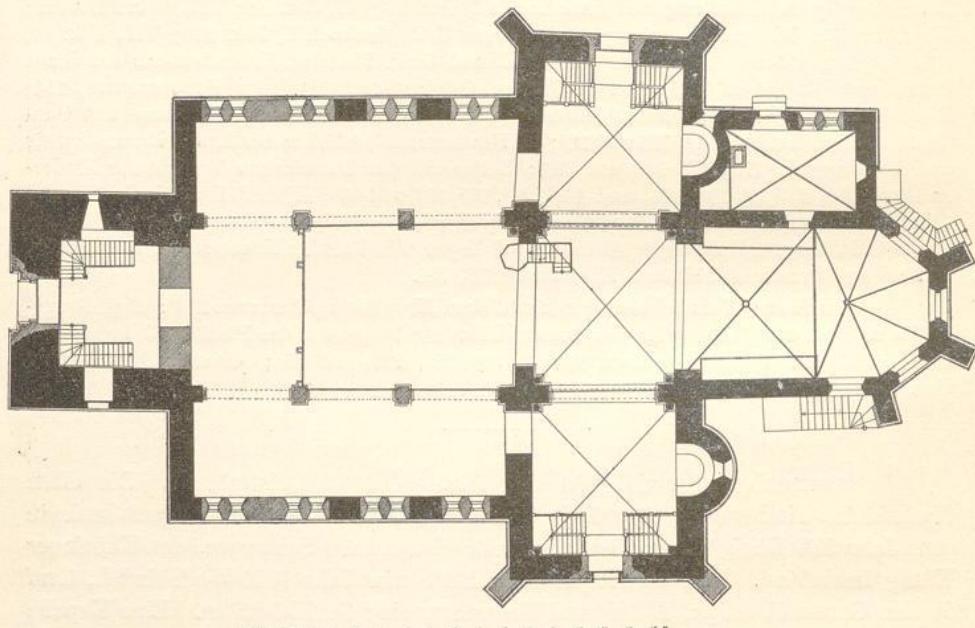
Kirche in Ronnenberg; Grundriss.
